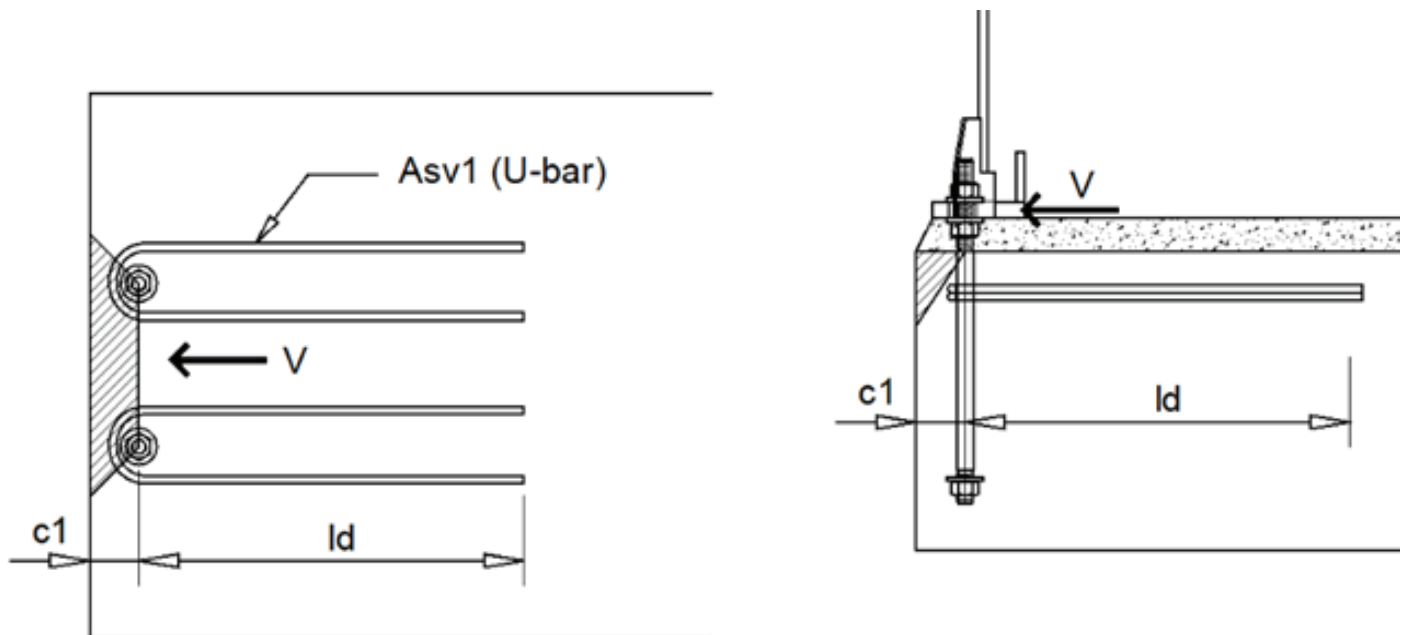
การเสริมเหล็กเพื่อด้านทานการวิบัติในรูปแบบผ่าซีก (concrete splitting)
